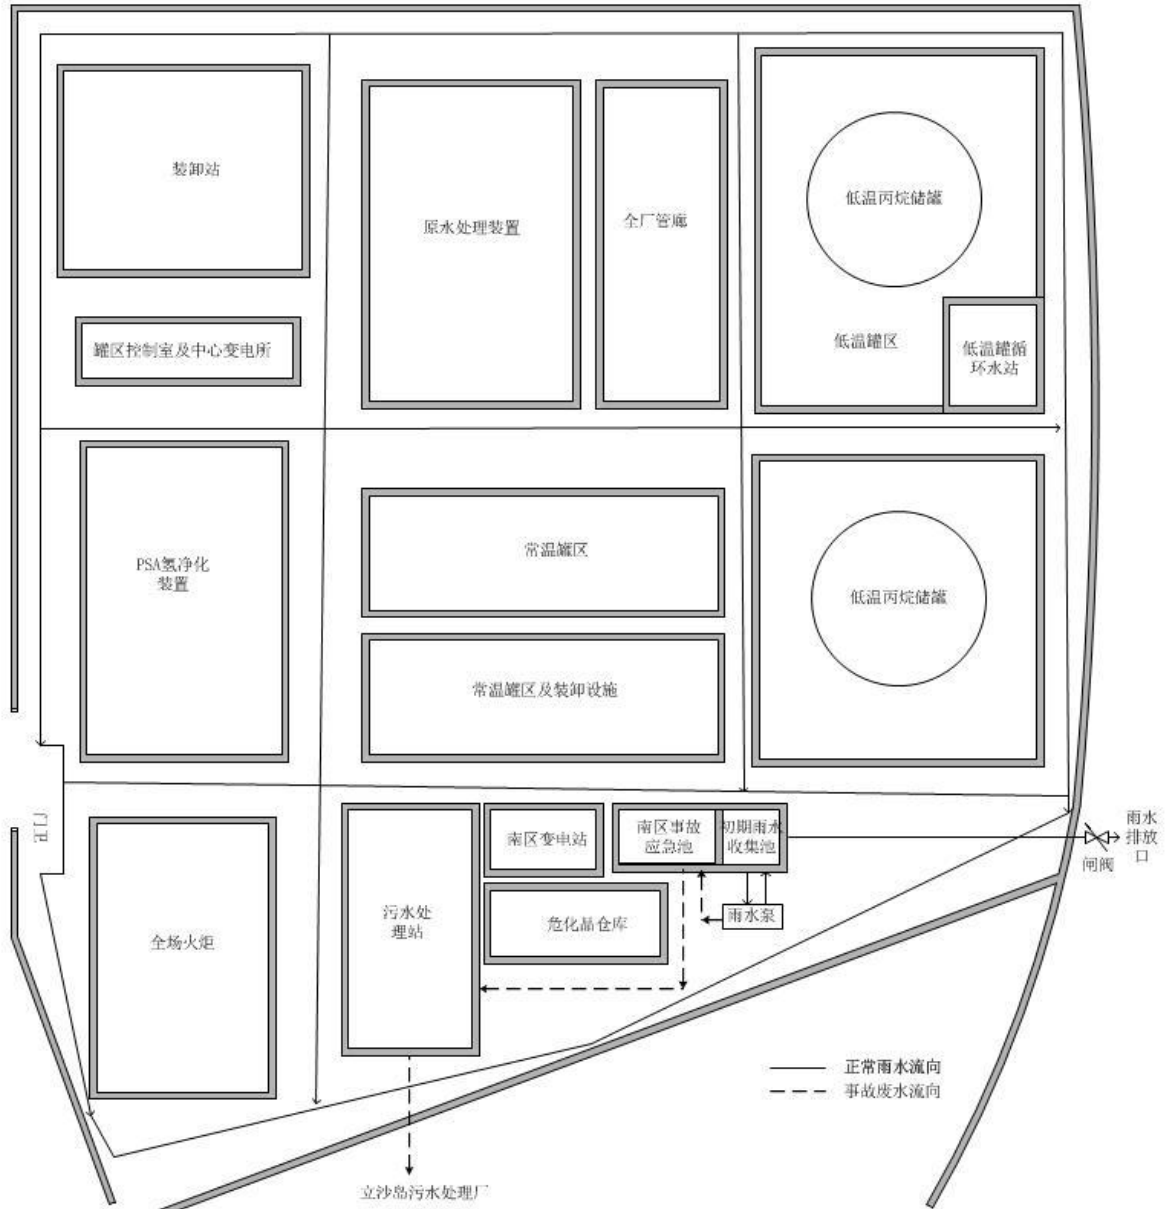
一期工程及其配套项目厂区总平面布置图
